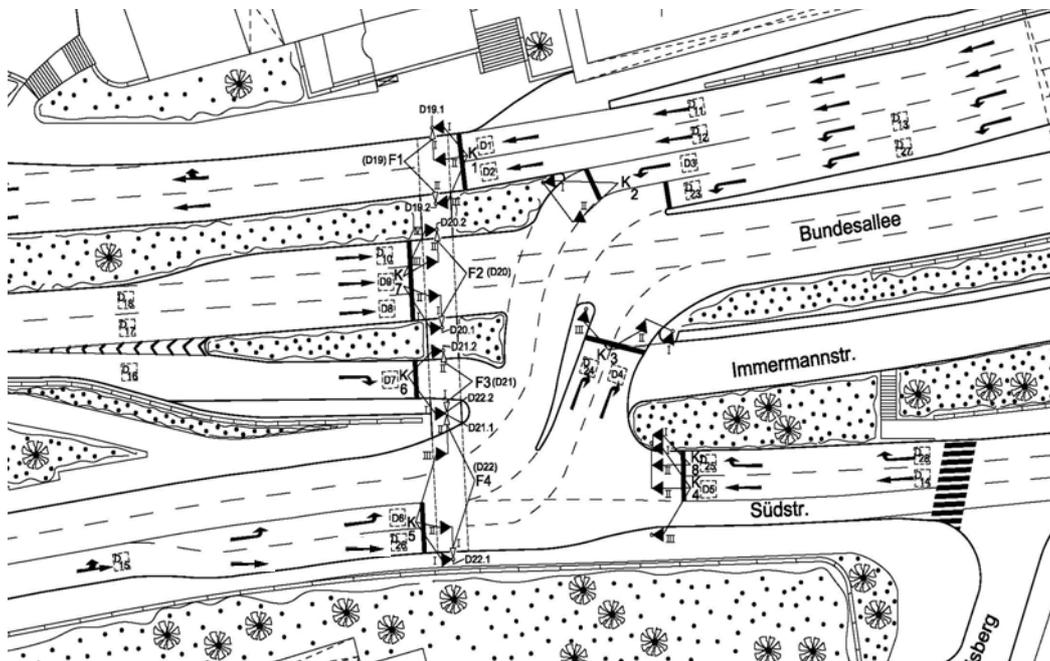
Signallageplan LZA 257, Bundesallee (B7)/Südstraße (bisherige Planung)
